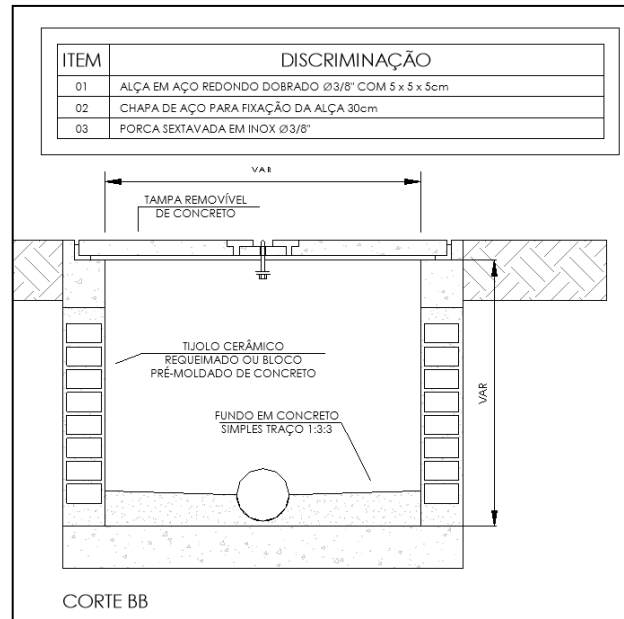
Detalhe caixa de areia com tampa de concreto
